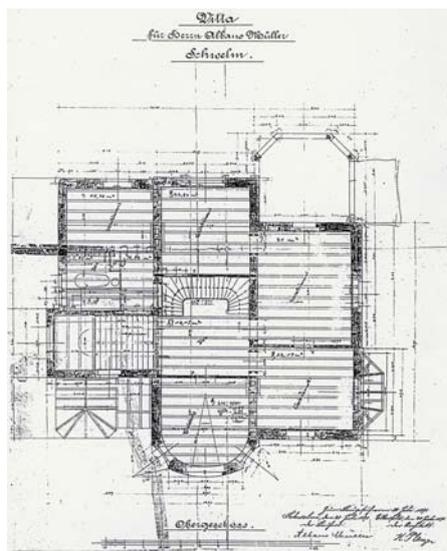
H. Plenge, Villa Albano Müller, Grundriss Obergeschoss, 1898
